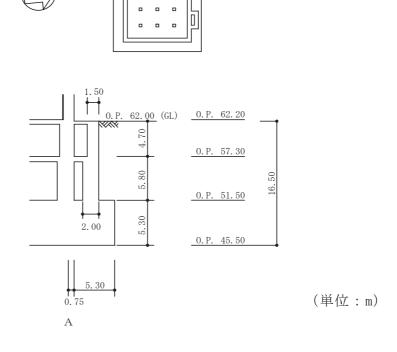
(2) 緊急時対策建屋の概略断面図 (B-B 断面, EW 方向)
